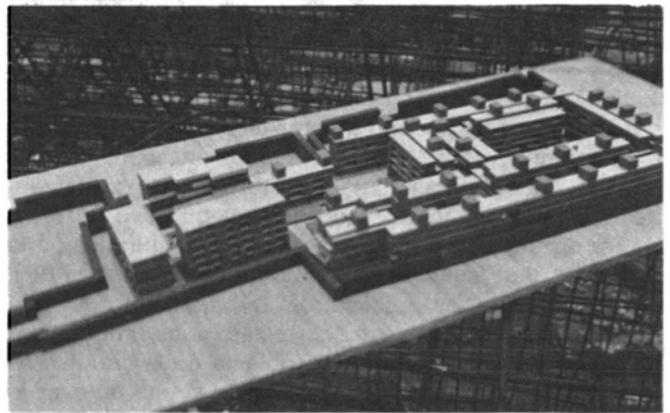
(y siguientes). Propuesta de vivienda con aprovechamiento de lotes baldíos y substitución de vecindades, como parte del Plan de Mejoramiento. Conjunto habitacional sobre la avenida Nonoalco (incluye, a la izquierda y al fondo, el conjunto Coahuatlán, proyectado previamente). Tesis profesional. Taller 5 del Autogobierno. 1977.
